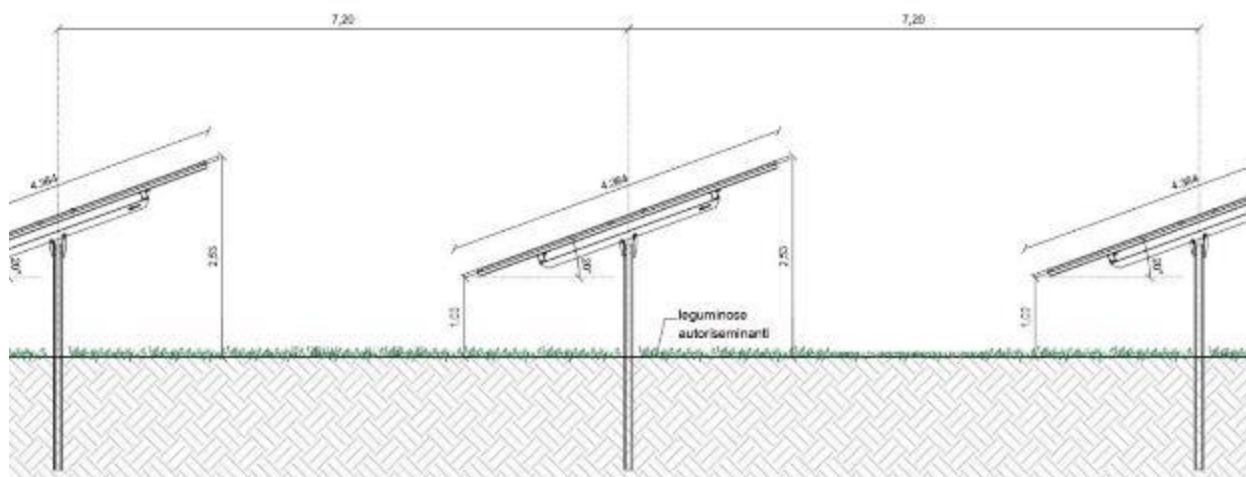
Particolare delle strutture di supporto dei moduli fotovoltaici
